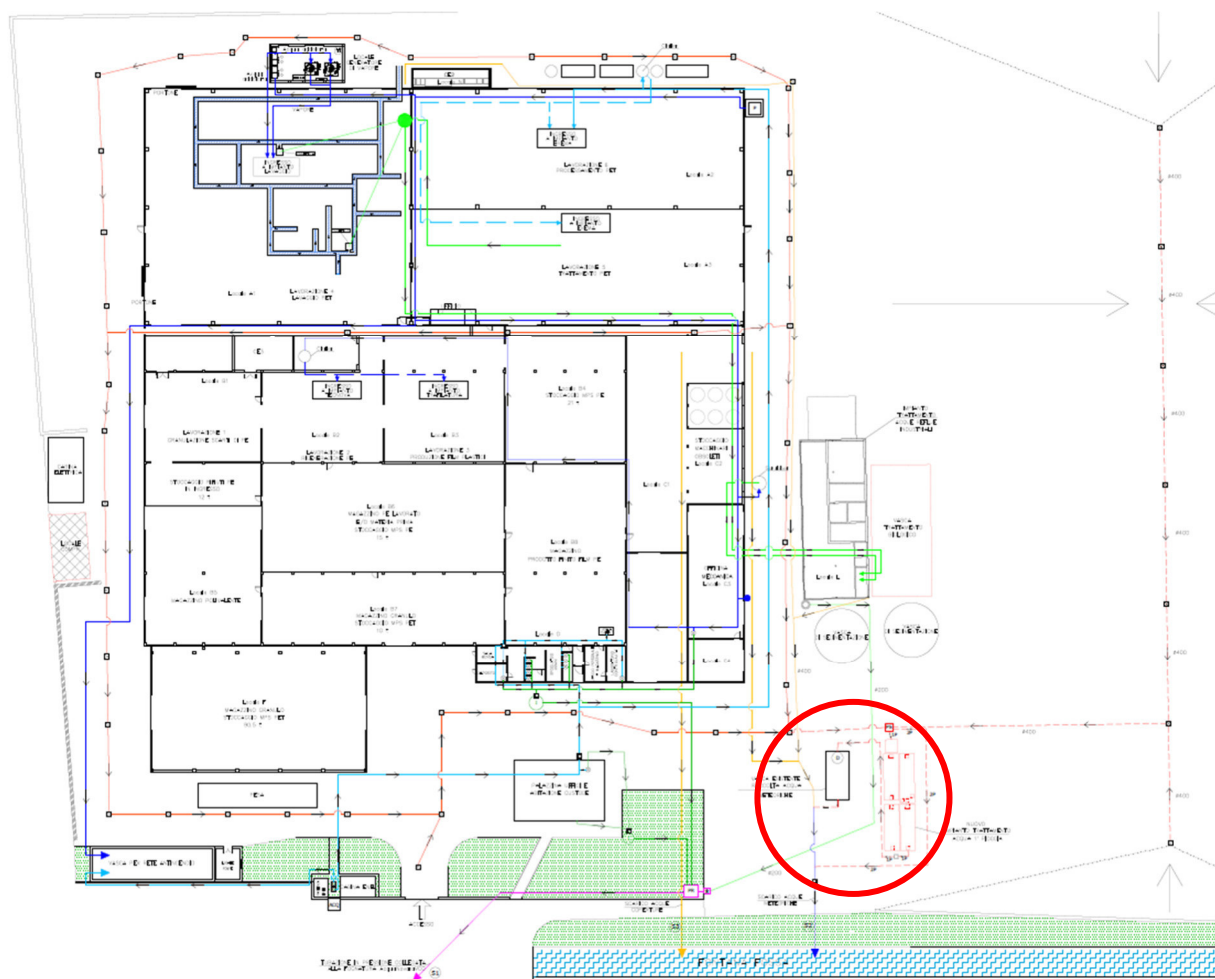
Estratto Planimetria delle reti fognarie – stato di fatto
